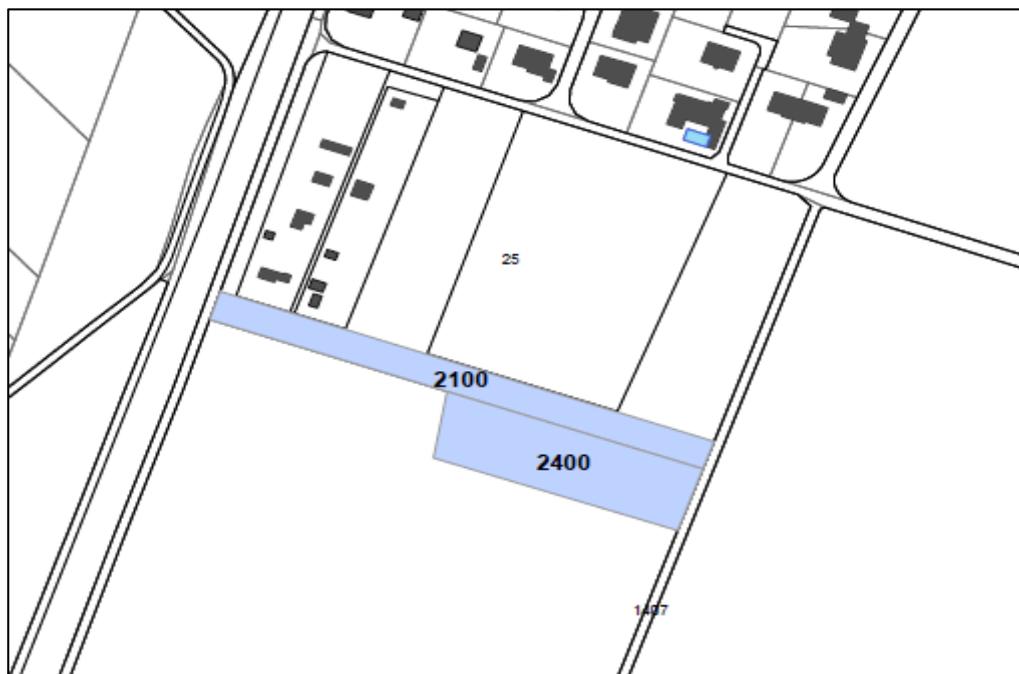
Mögliches Rückhaltebecken mit Flächenangabe in m<sup>2</sup>
